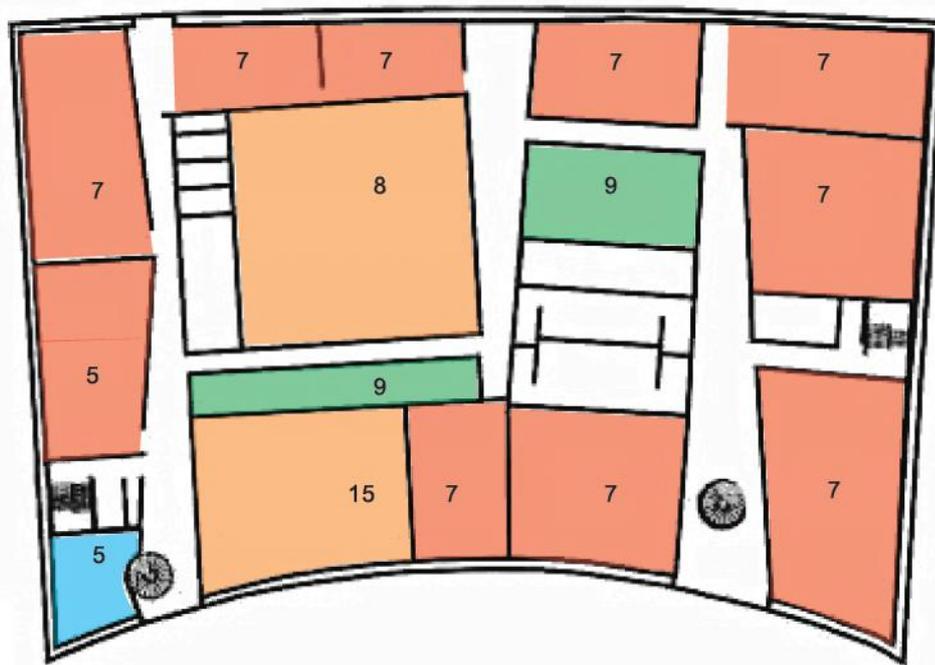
PLANTA SEGUNDO PAVIMENTO – SEM ESCALA
